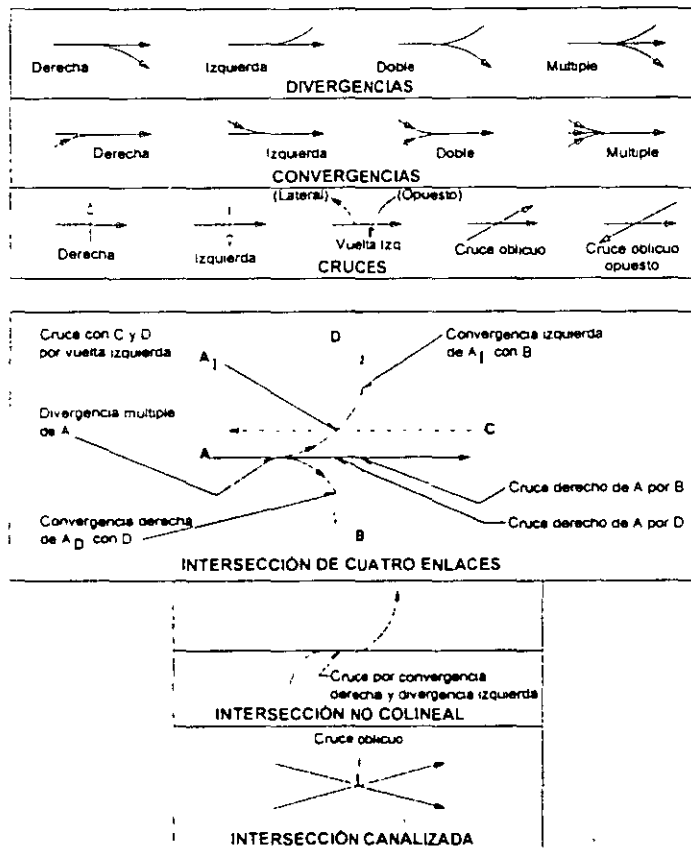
MANIOBRAS DE LOS VEHICULOS EN LAS INTERSECCIONES
